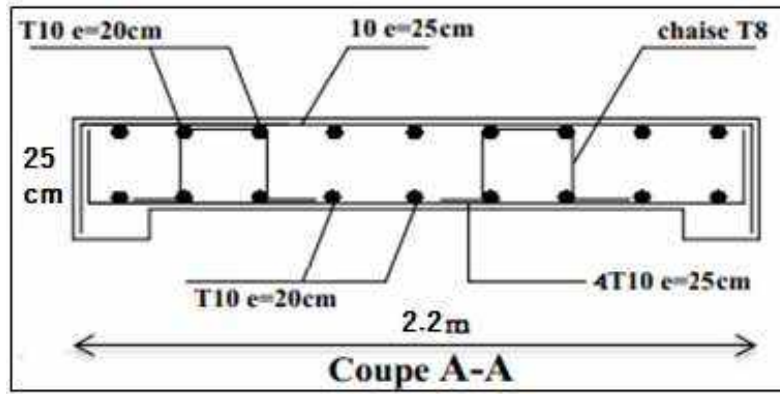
Ferrailage de la dalle machine coupe A-A
